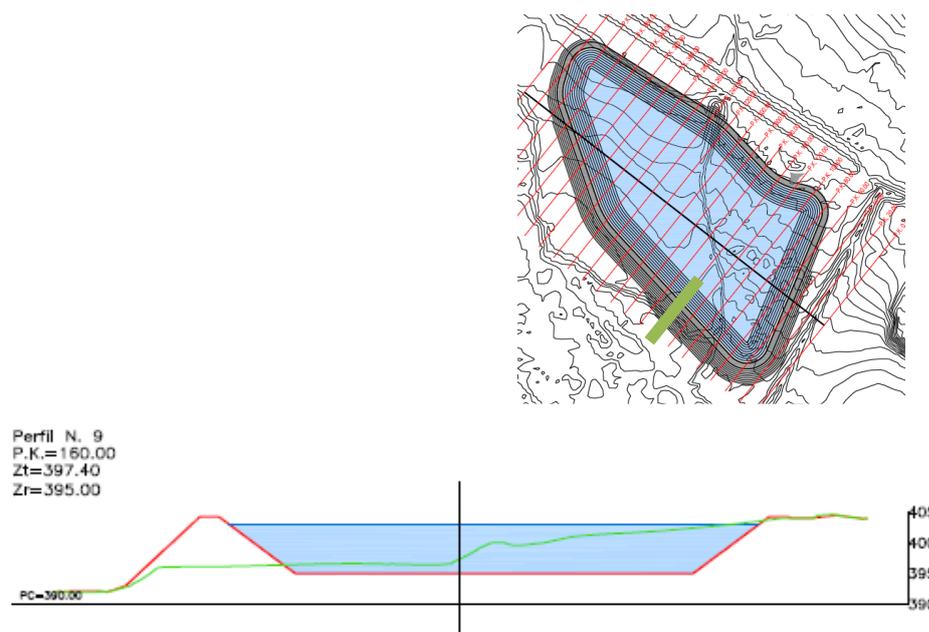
Localización brecha en planta y perfil (plano 6 de proyecto perfil transversal PK 160)
